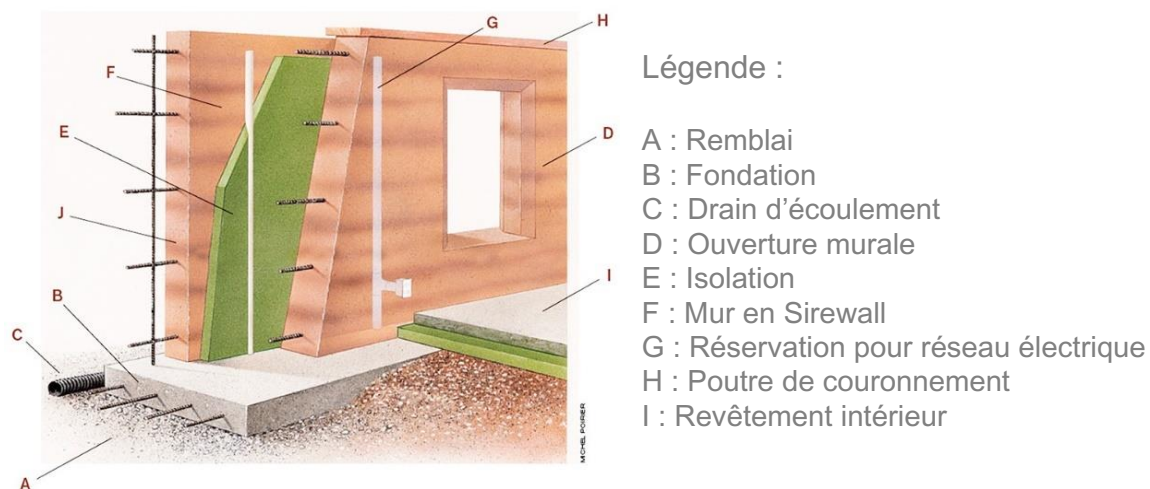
Détail de construction d'un mur en « Sirewall » (source : sirewall.com)
